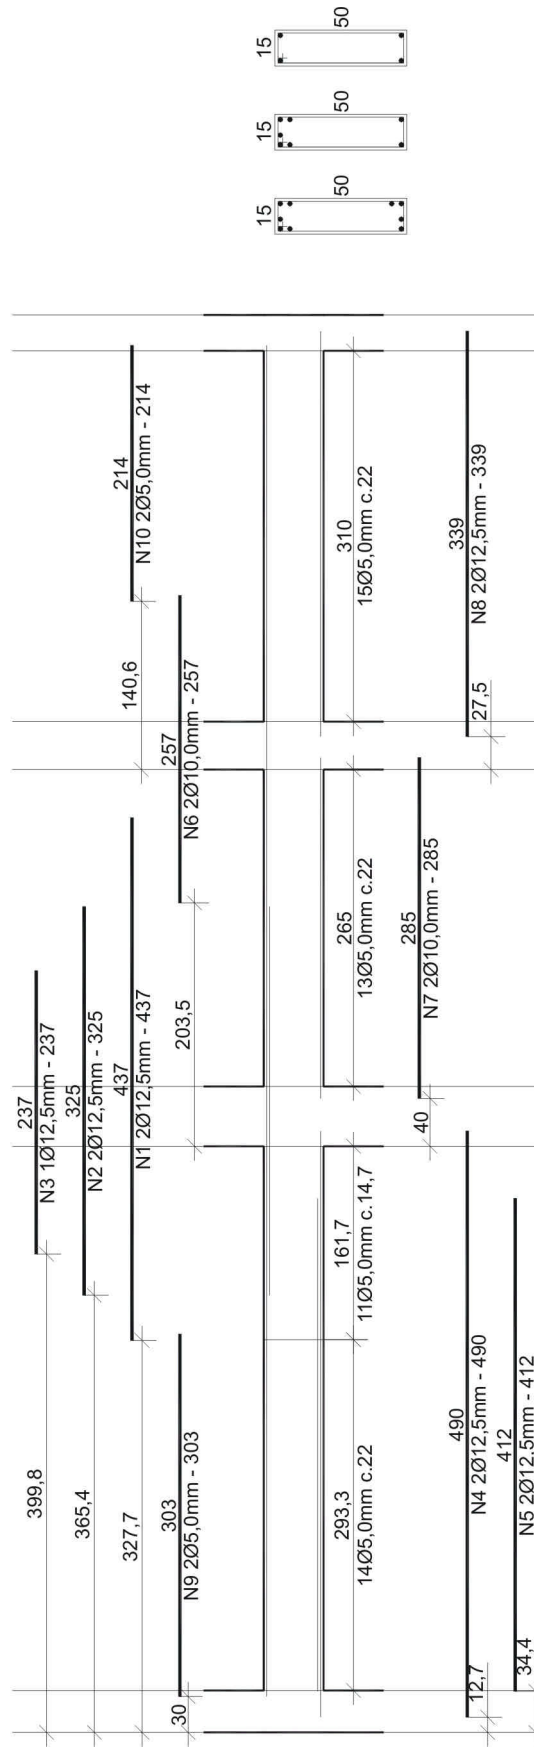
Detalhamento Viga 04.9, realizado pelo VigaCalc.
